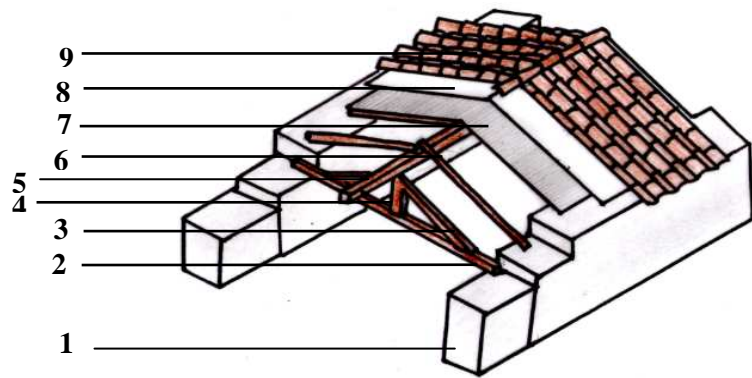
Ferme en bois, Maatkas. (Source : Auteur)
